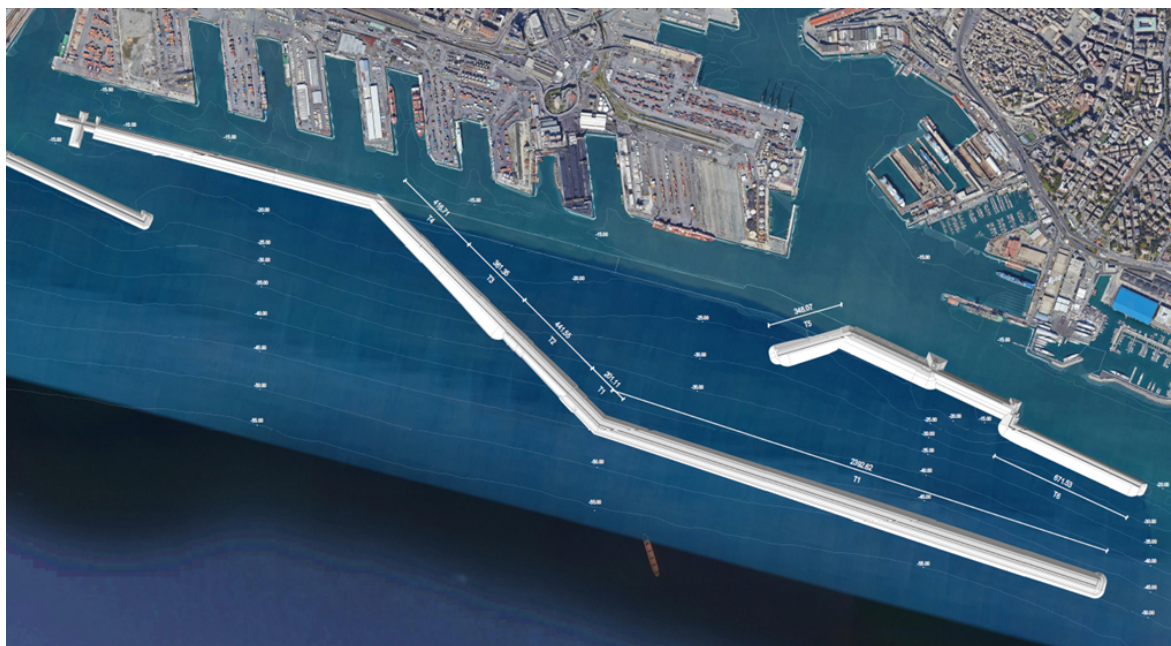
Planimetria della configurazione di progetto della nuova diga.
